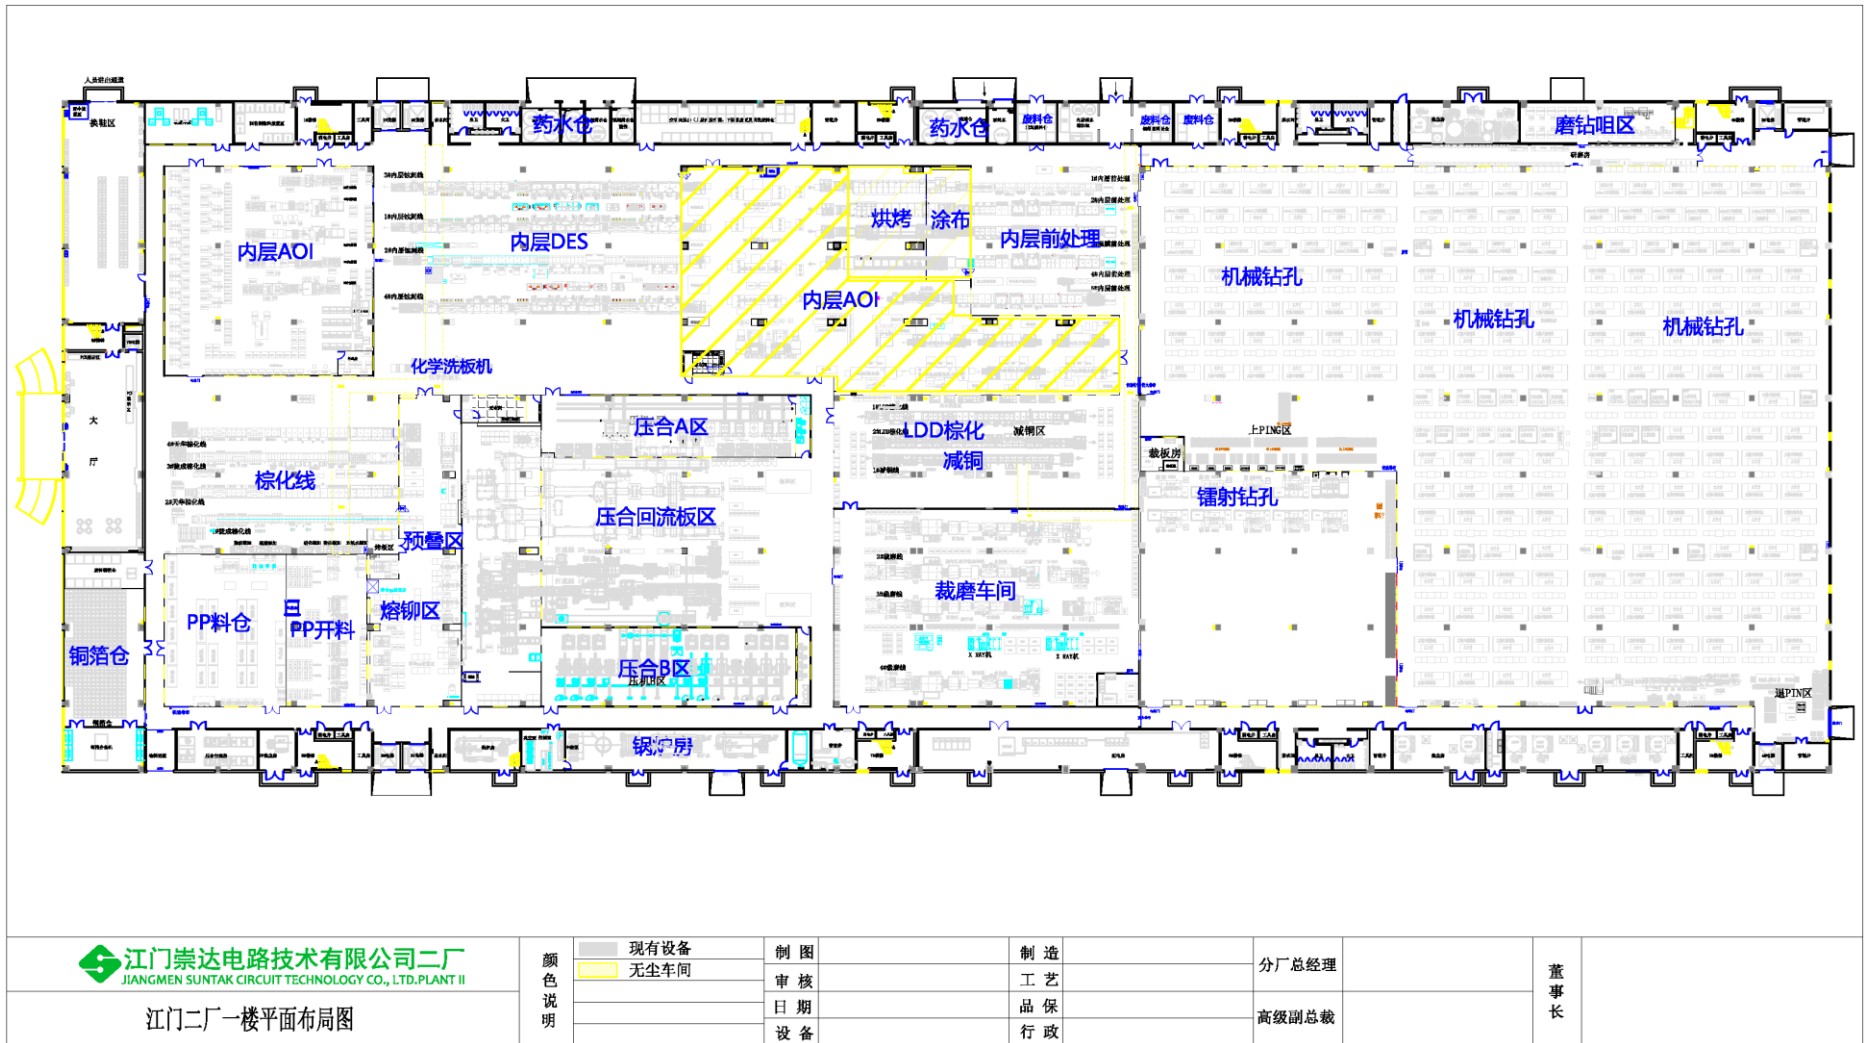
(d) 现有项目厂房二 1F 车间平面布置图
